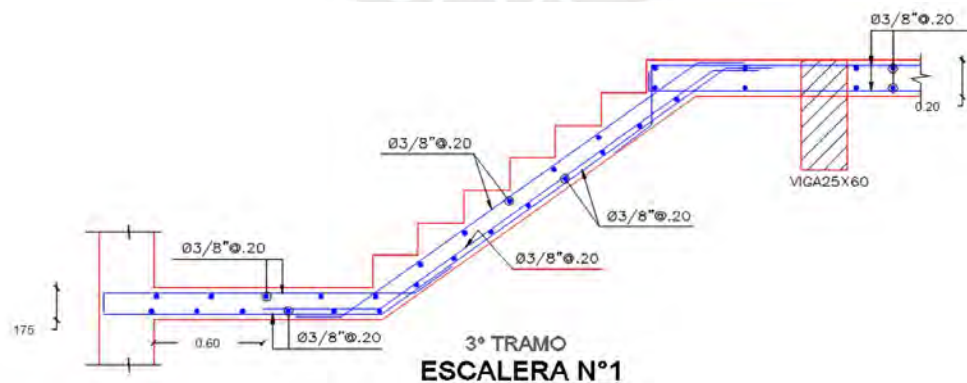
Detalle del refuerzo para el 3er tramo de la escalera.
